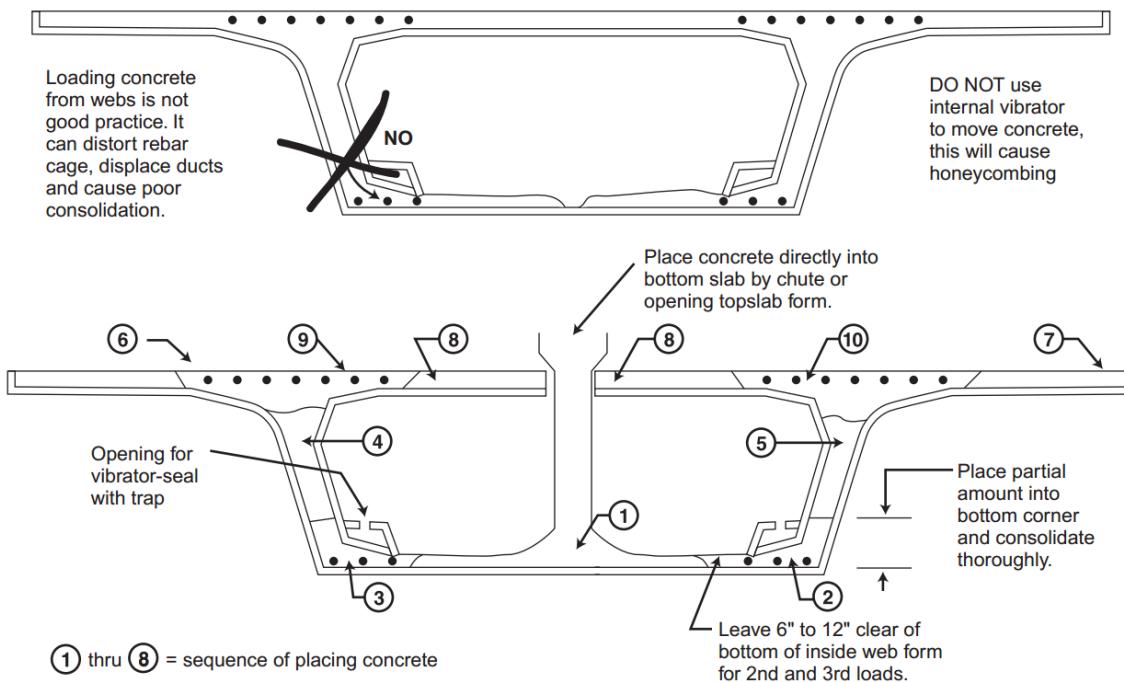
Colocación de concreto en los segmentos tipo cajón.
